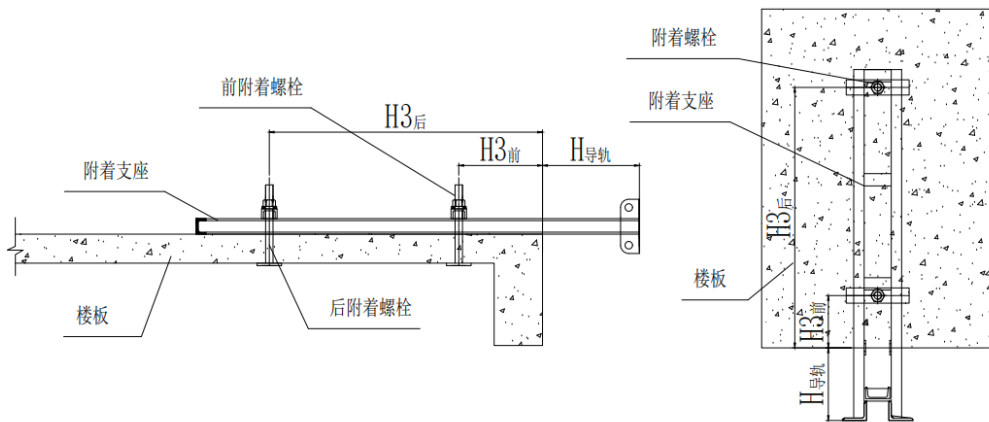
双附着螺栓垂直于楼板布置位置示意图
